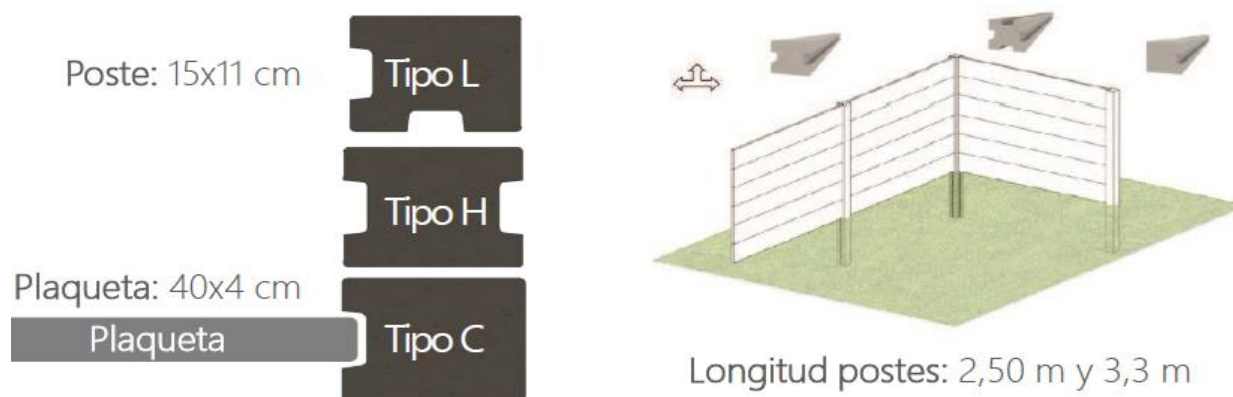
“Proyecto Vivir” Elementos de construcción prefabricados. Fuente: PREMOLDEADOS SAS, 2024
